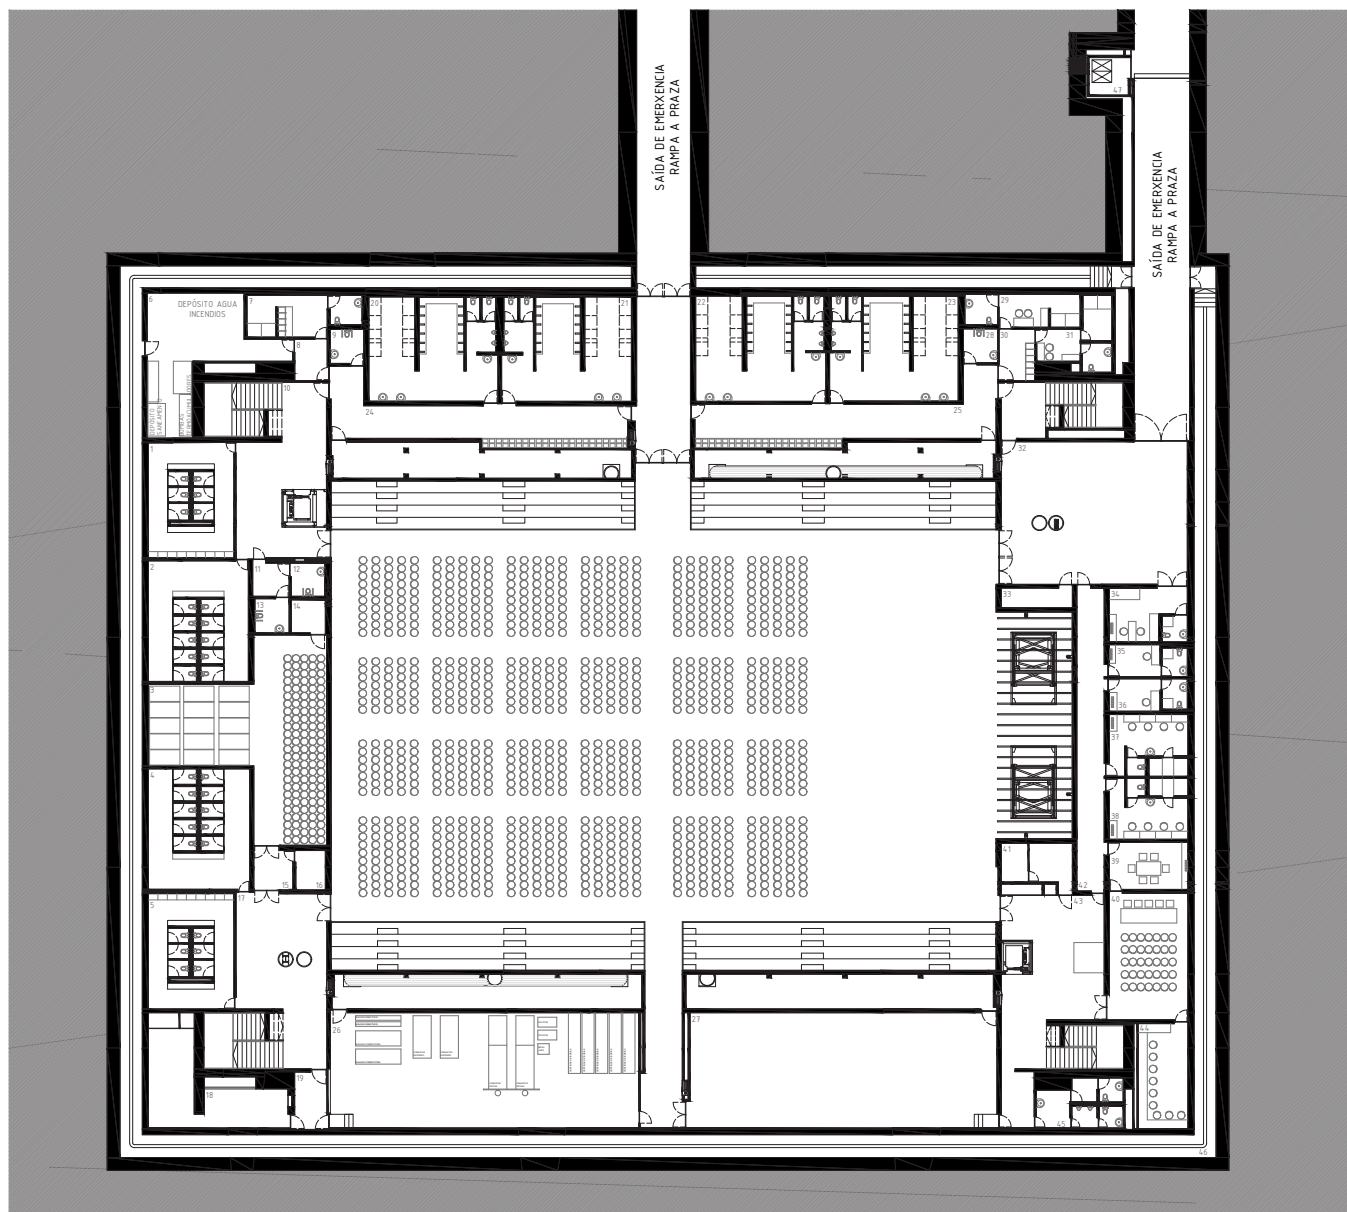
Planta de acceso do Centro Cultural. Escala 1/350.
